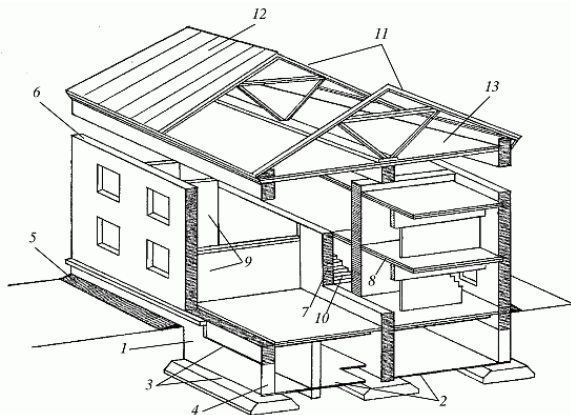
Схема двухэтажного дома: 1 – фундамент; 2 – пол подвала; 3 – гидроизоляция; 4 – стены подвала; 5 – отмостка; 6 – наружные стены; 7 – внутренние стены; 8 – междуэтажные перекрытия; 9 – перегородки; 10 – лестница; 11 – стропила; 12 – кровля; 13 – чердачное перекрытие
